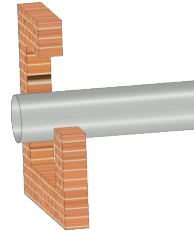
Massivwände - Trockeneinbau - Mineralwolle mit Brandschutzanstrich
